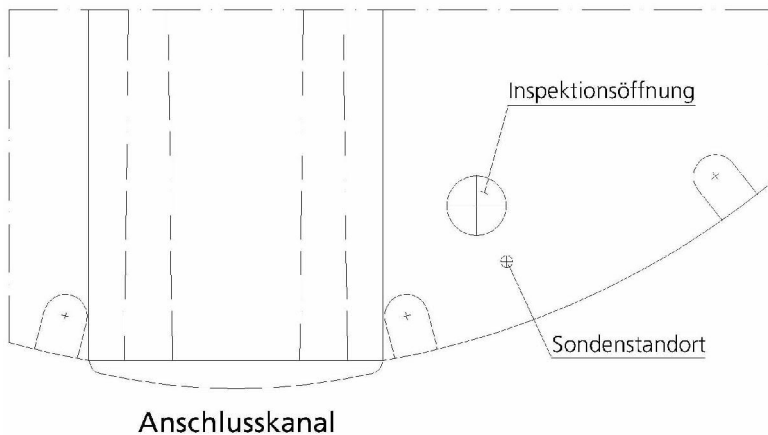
Platzierung der Sonde im Eisspeicherdeckel (Grundriss)
